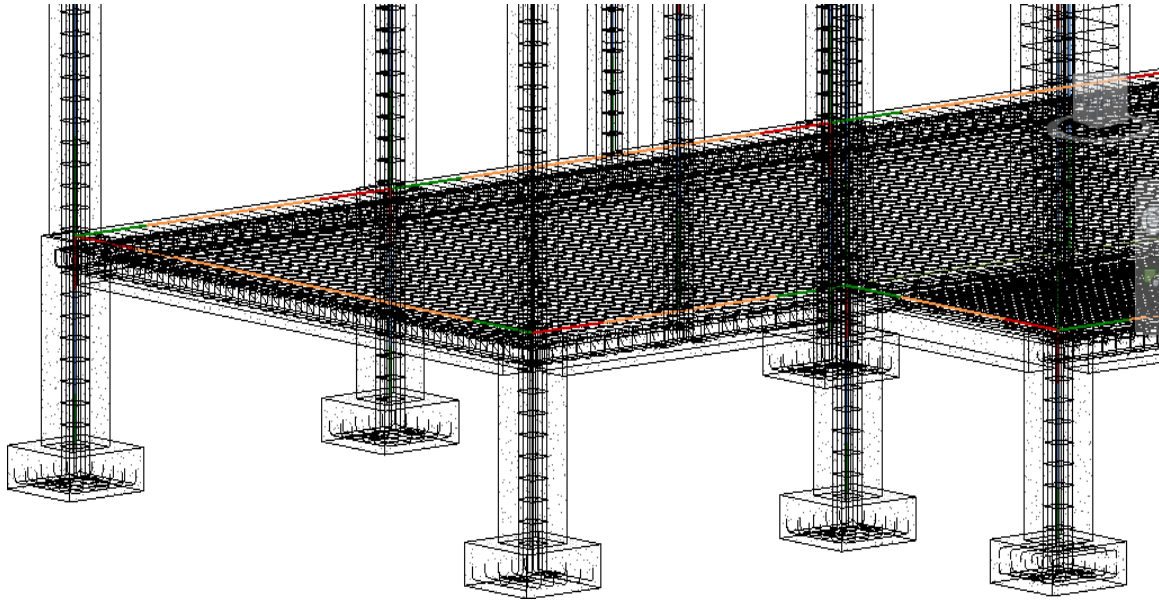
Plano de techo del modelo estructural de la capilla en estudio
